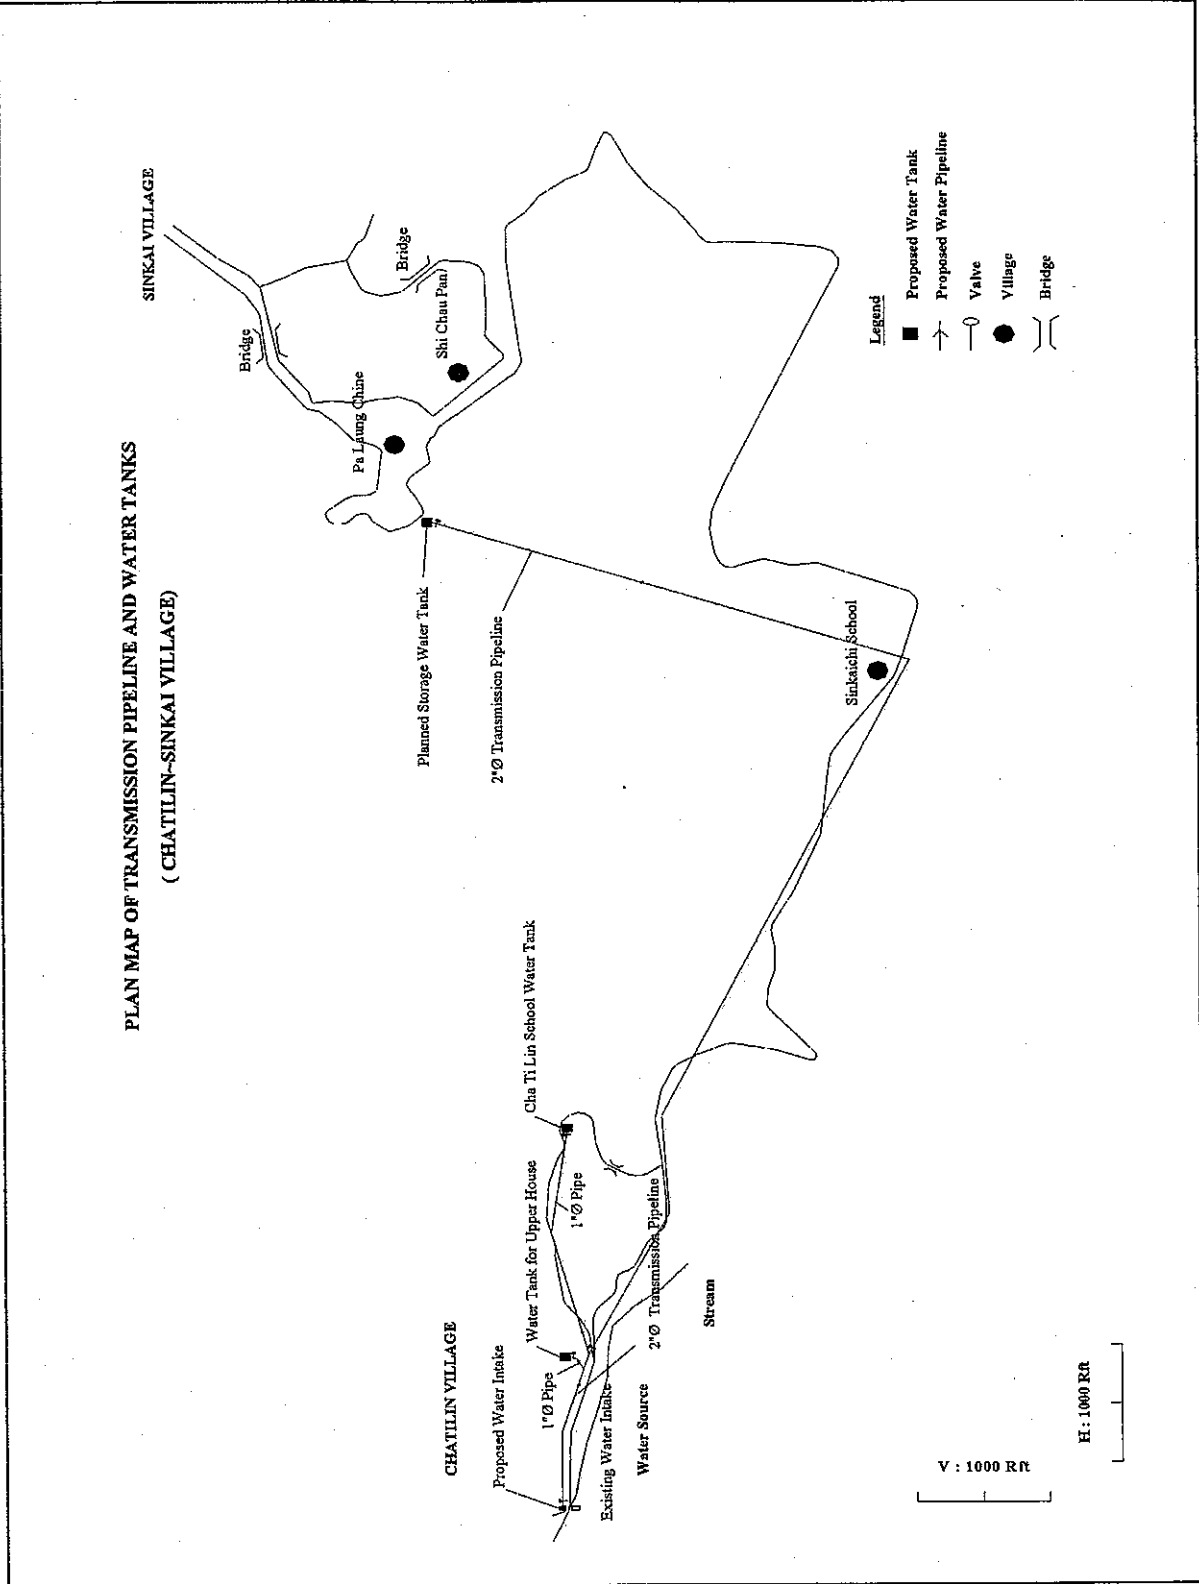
シンカイ (チャーティリン) 飲料水給水施設整備計画平面図 (その1)
